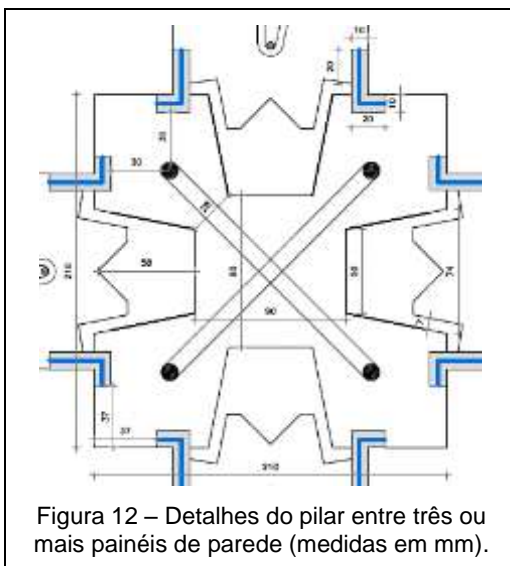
Detalhes do pilar entre três ou mais painéis de parede (medidas em mm).
